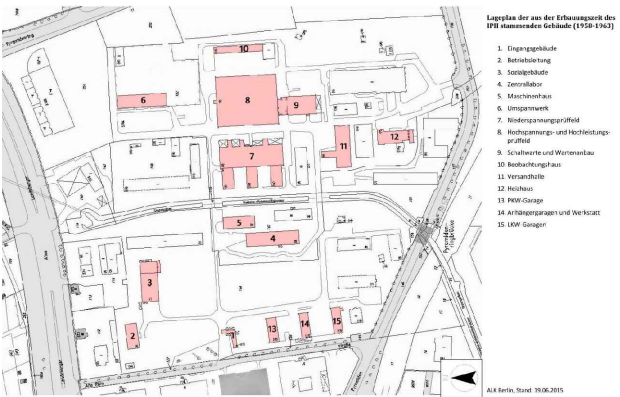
Lageplan aus der Erbauungszeit des IPH stammenden Gebäude (1958-1963)
